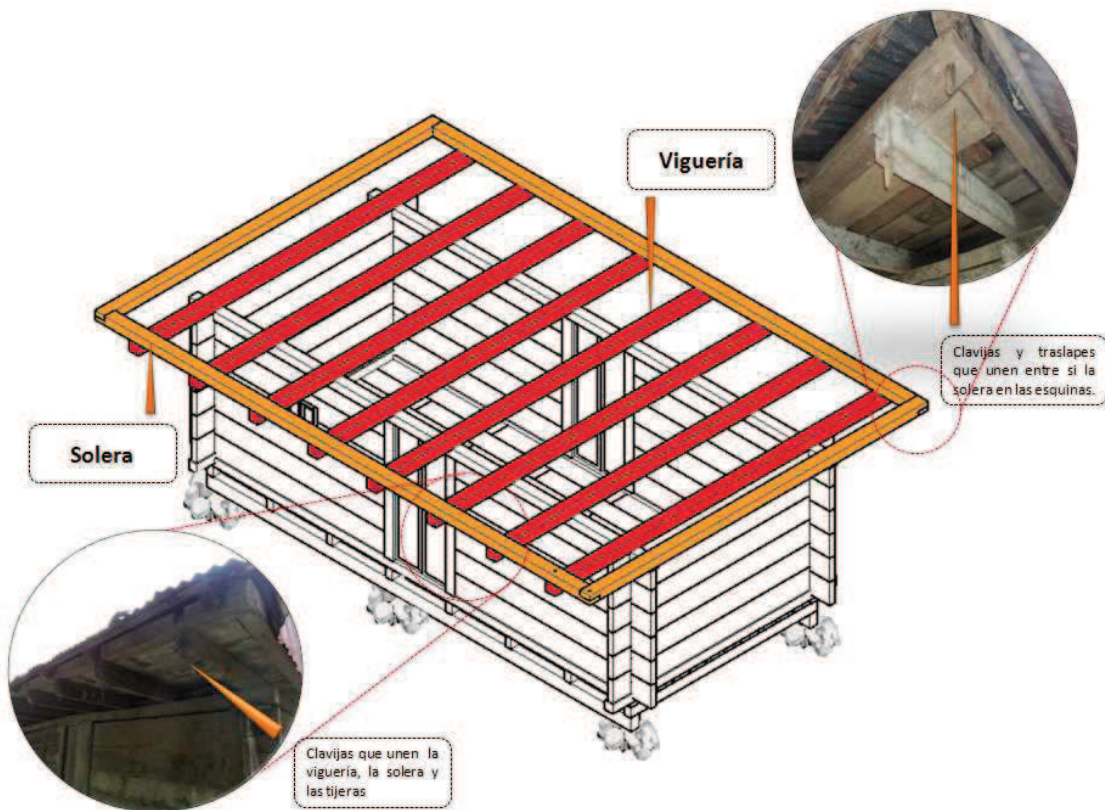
Detalles de la estructura de soporte y uniones de la cubierta de una casa de viguetas. En rojo aparece la viguería y en amarillos la solera.
